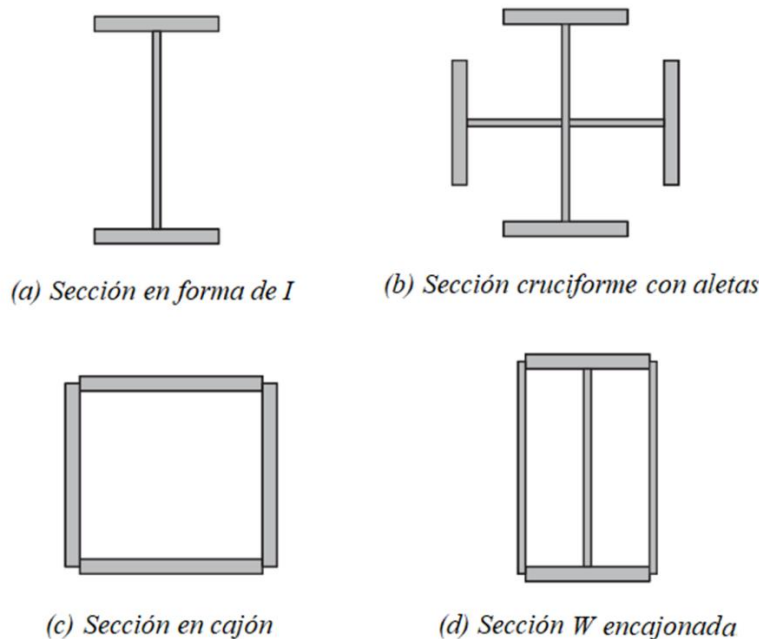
Secciones transversales de columnas. No se muestran la preparación de las placas ni las soldaduras.
